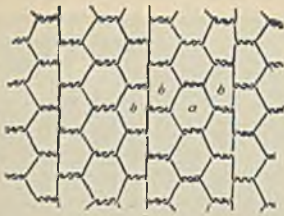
(oben). Benzinger-Geflecht (Sechseck-Grundgeflecht mit Bewehrungsstäben).
